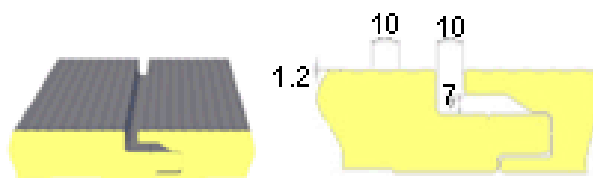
Pormenor da zona de encaixe do painel de fachada
